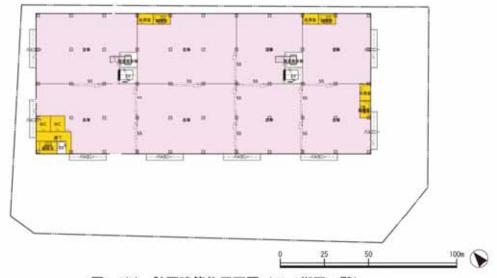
(3) 計画建築物平面図 (46-2街区 4階)
